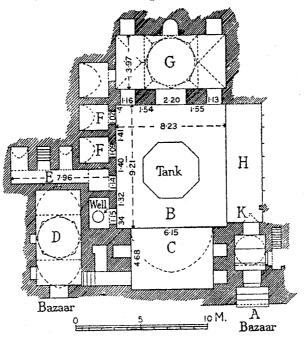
مسقط أفقي لجامع الدرويشية بدمشق (عن : سوفاجيه) .
